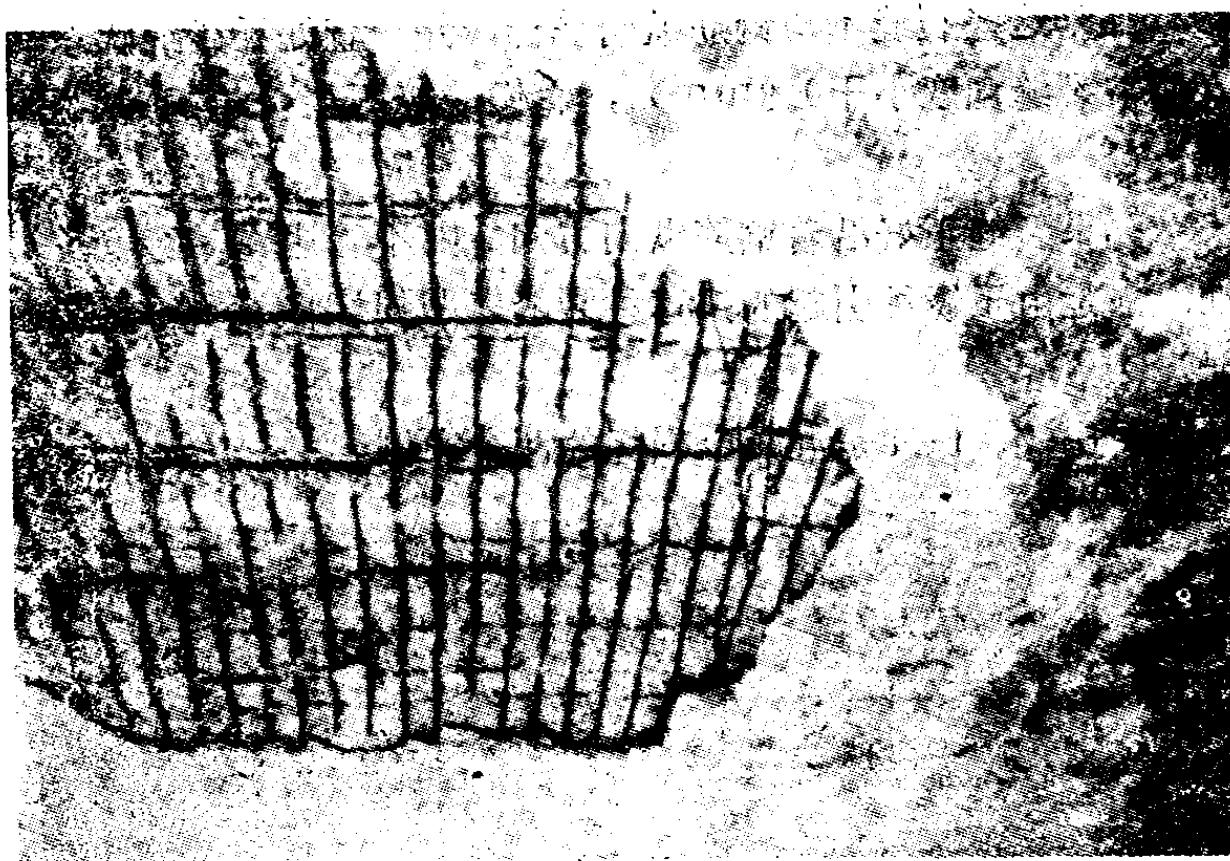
8 巴林岛通廊顶部的混凝土严重剥落，毫无疑问是混凝土质量很差，钢筋保护层很薄。有砂浆垫层的（图右端）就比全都是混凝土的防护效果要好。即使早期出现损坏，如果对混凝土进行了一定的检验，图中所出现的损坏也能预测
